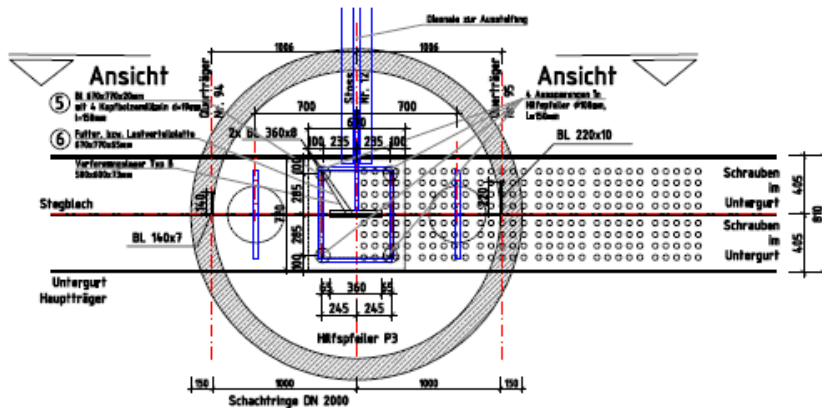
Lasteinleitungspunkte Hilfsstützen, Bereich P4 – Draufsicht – Ausführungsplanung (© Ed. Züblin AG)
